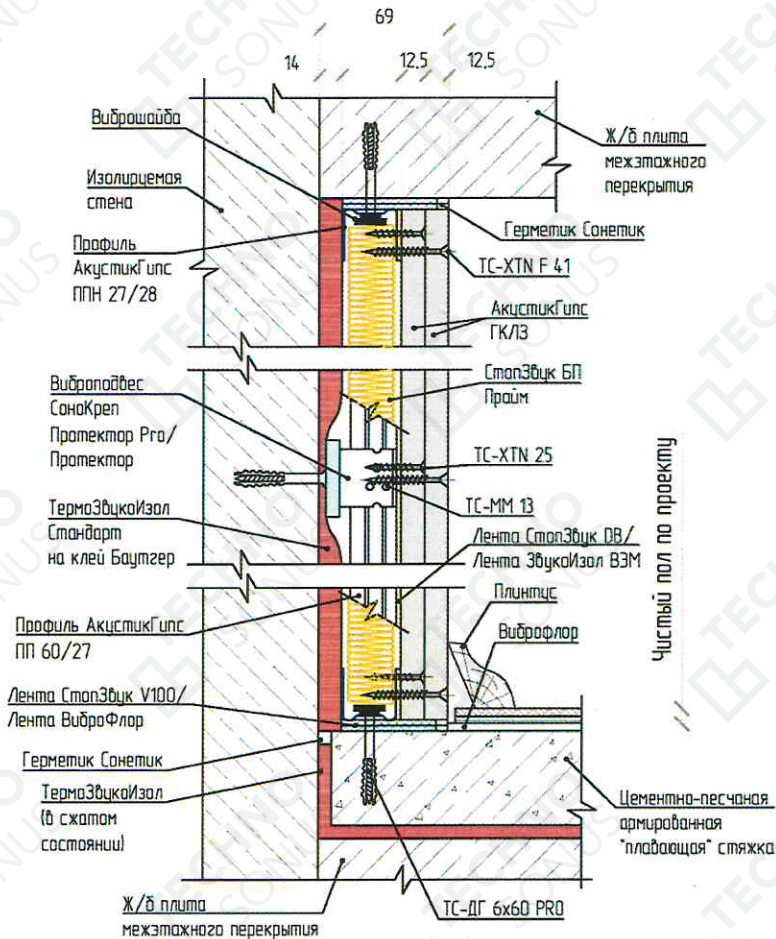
Примыкание облицовки стены «Базовая» к «плавающей» стяжке пола и к плите перекрытия
